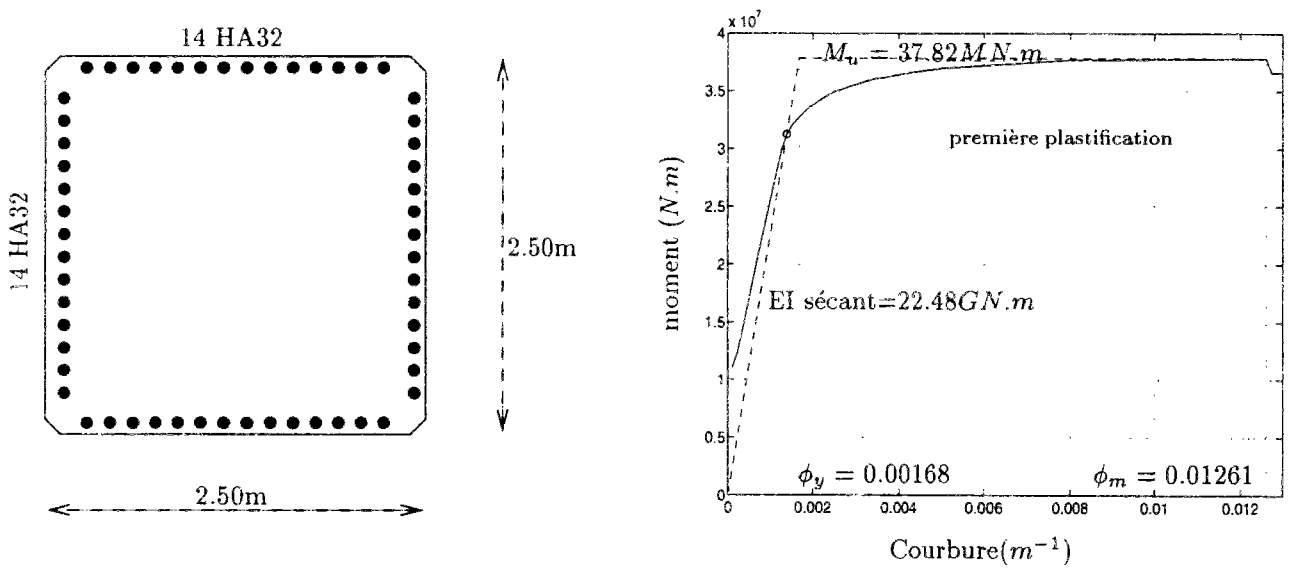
Section transverse en pied de pile P2. Plan de ferrailage longitudinal et diagramme moment-courbure
